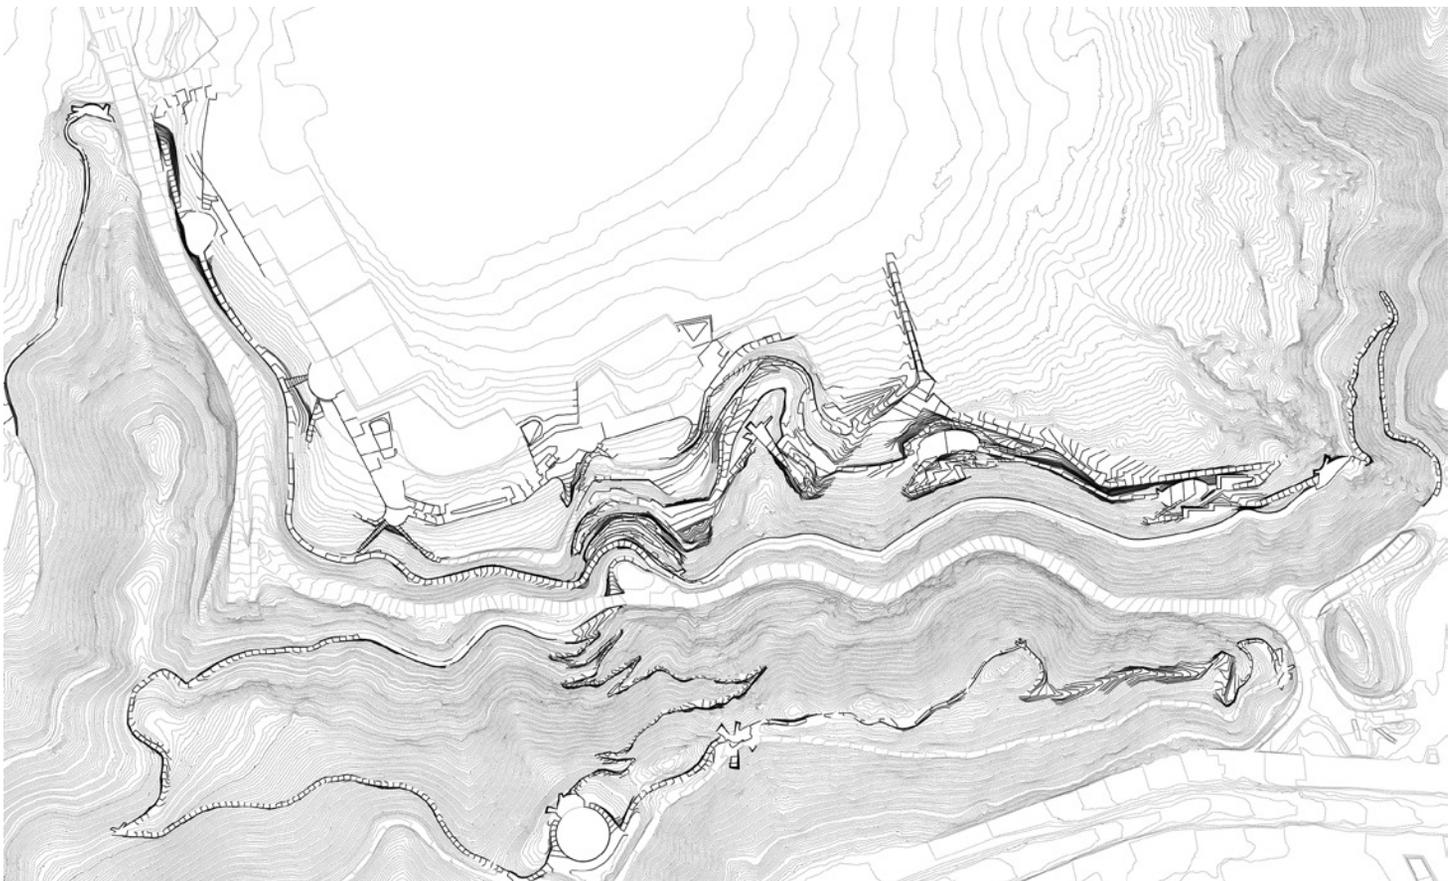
Planta topográfica. Fuente: elaboración propia, 2023.
